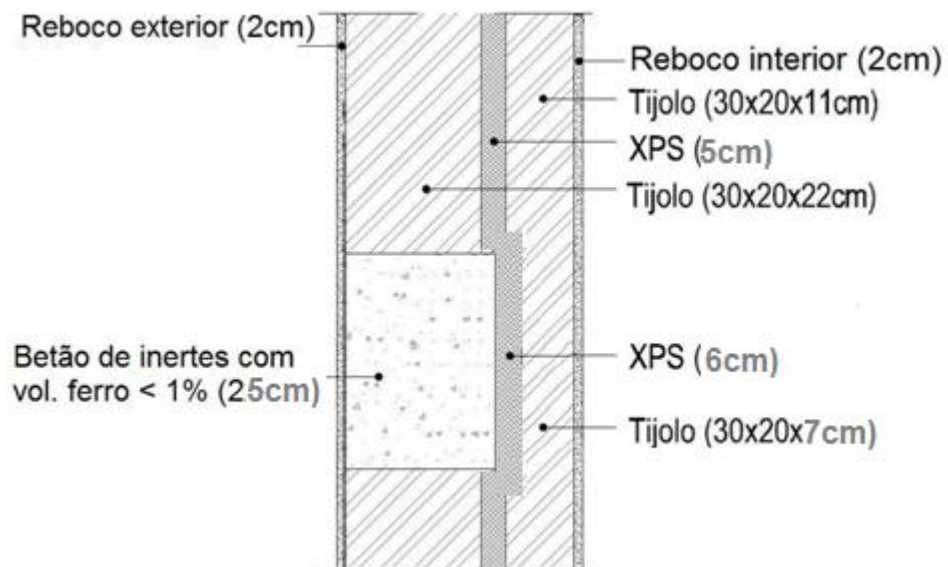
Elementos exteriores do tipo 1: parede (ParExt2) e pilar (PilarE).
